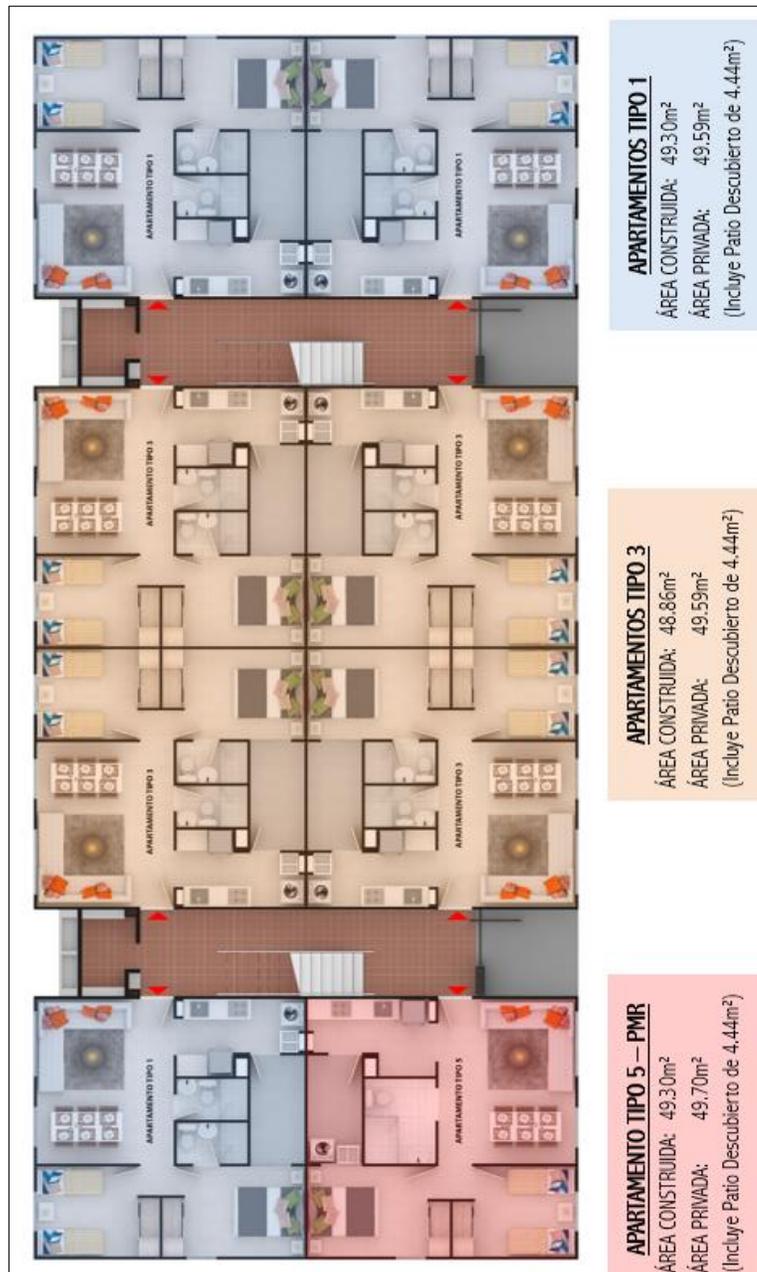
Vista en planta apartamento tipo 1-3-5
